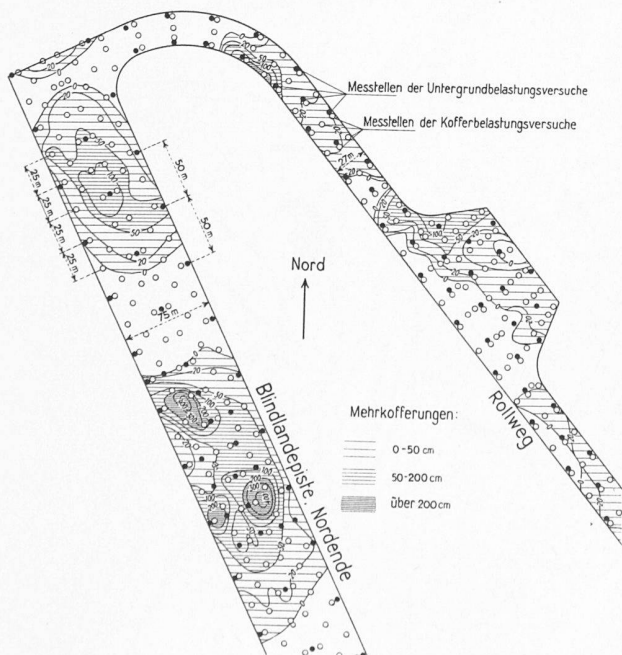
Pisten- und Rollwegausschnitt mit Angabe der vorgenommenen Baugrund- und Kofferprüfungen und mit reliefartiger Eintragung der erforderlichen Mehrkofferungen unter den Betonbelägen, M. 1: 6000
